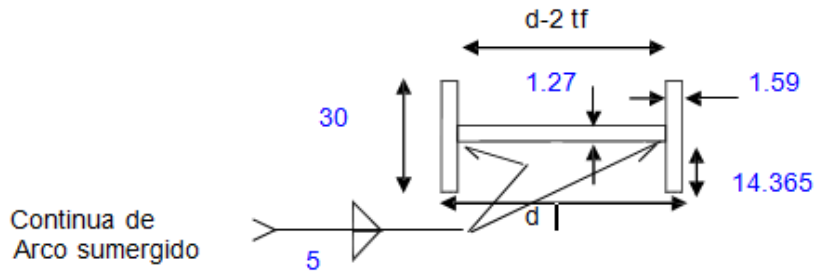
Detalle soldaduras en columnas.
